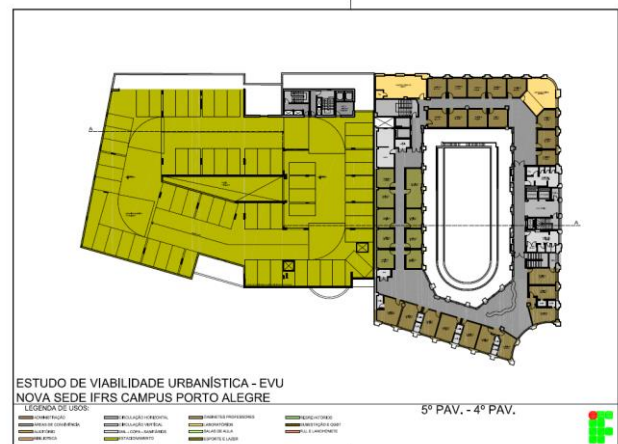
Planta baixa 2º andar - EVU- IFRS Poa
